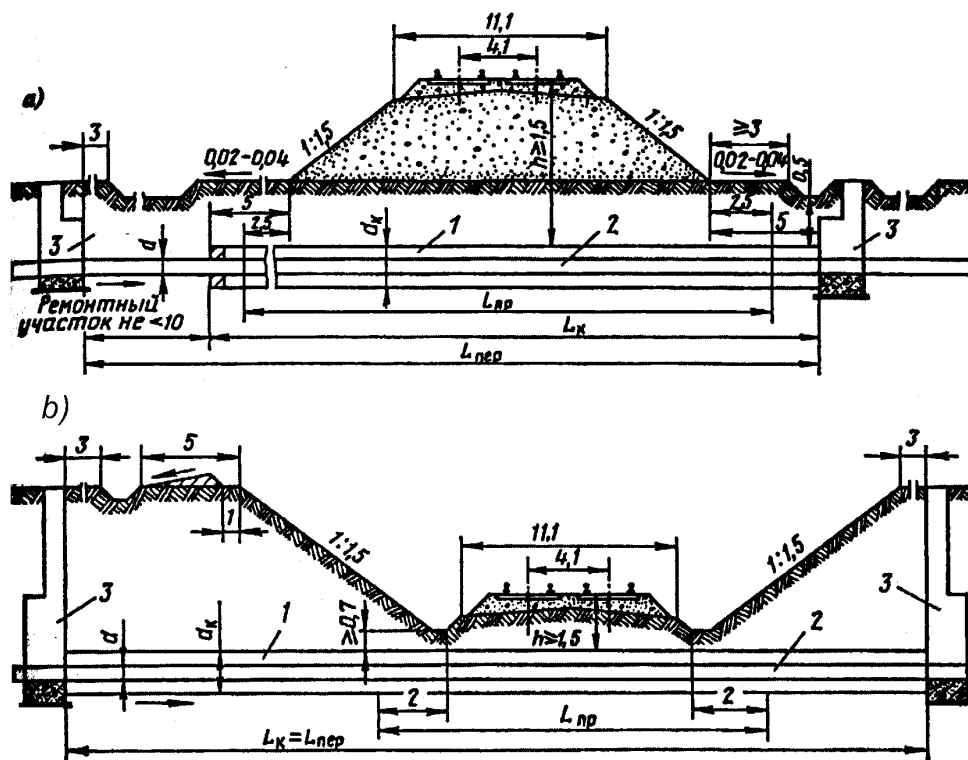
Переходы трубопроводами водоотведения под железнодорожными путями на перегоне:
